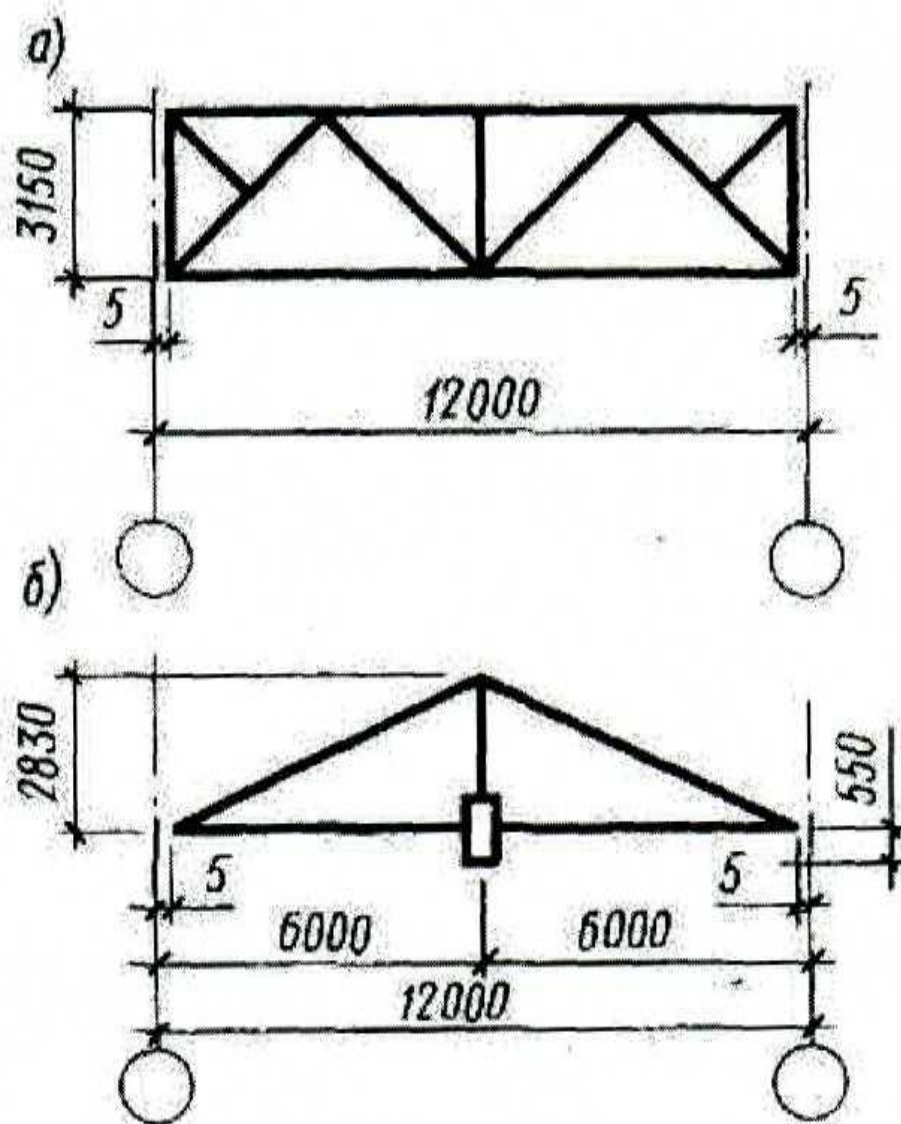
Стальные подстропильные фермы: а - из горячекатаных профилей; б - из электросварных труб
